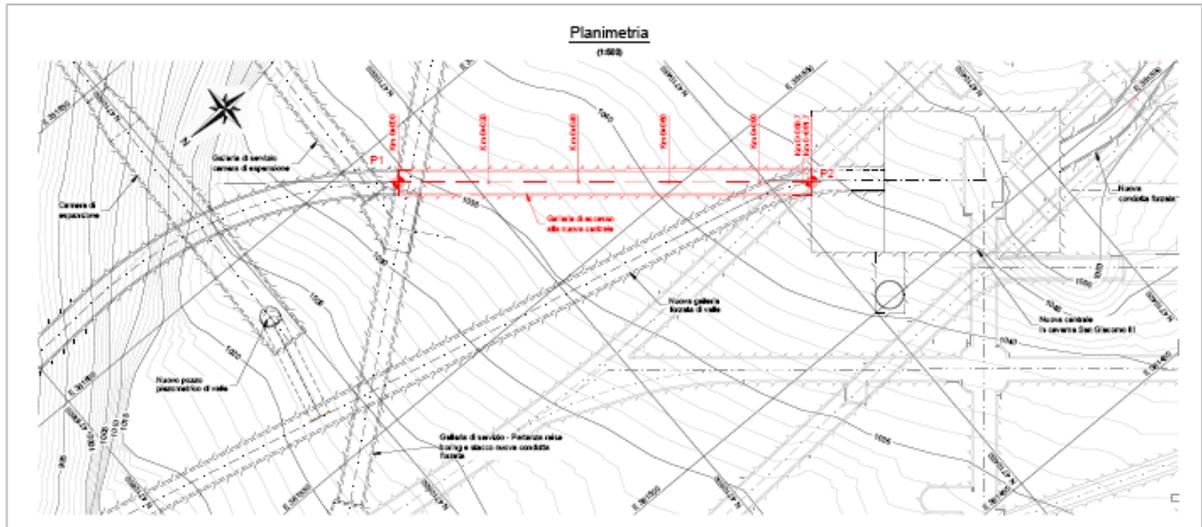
Galleria di costruzione della nuova centrale in caverna – pianta
